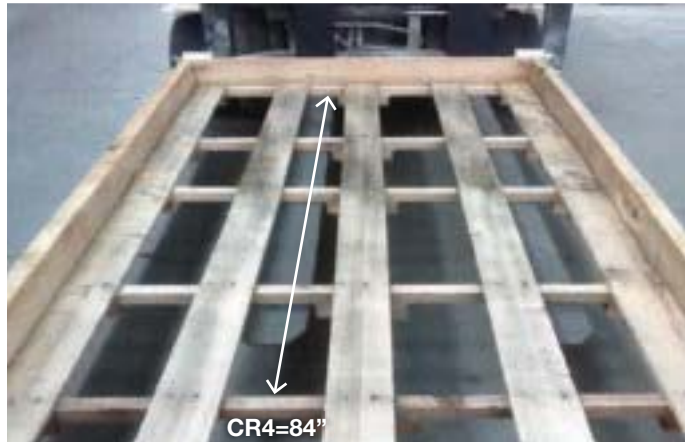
CAJA DE LAMINAM – RIELES CRUZADOS Vista desde abajo con horquillas de 84"
